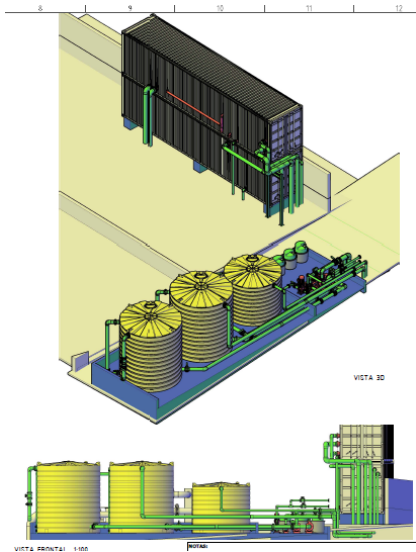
Planta propuesta Fuente: Proyecto Planta desaladora GO (Entregada por la empresa)
